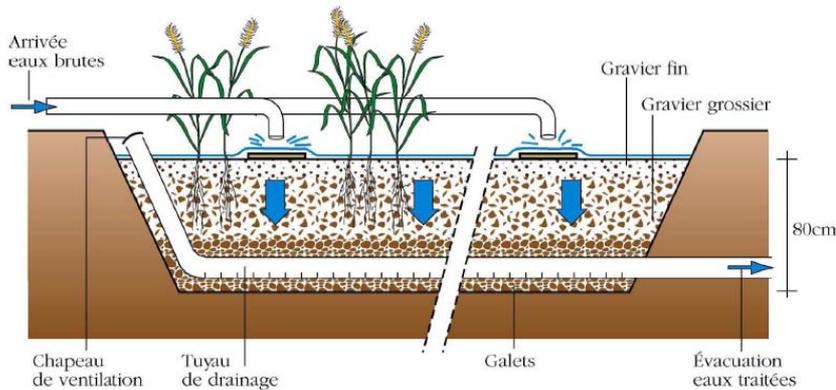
Coupe transversale schématique d'un filtre à écoulement vertical¹
